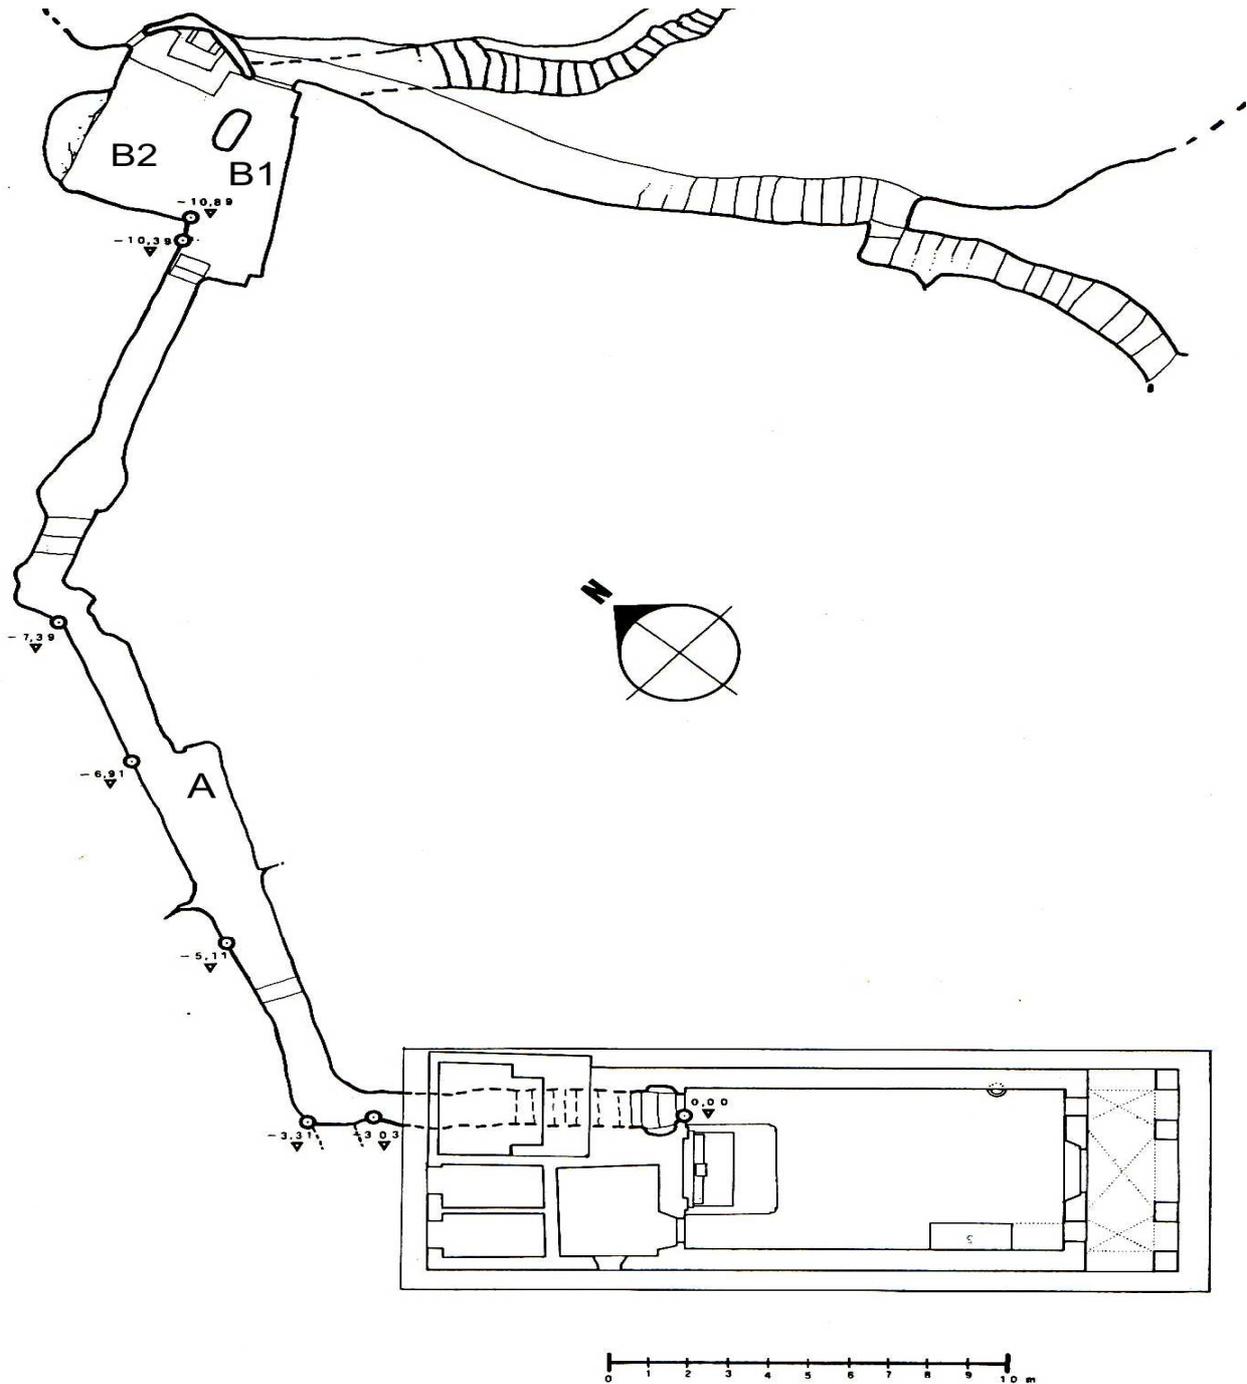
Complesso di S. Vivenzio, planimetria generale (fonte: Ricci et al. 1992b, modificato dall'autore).
